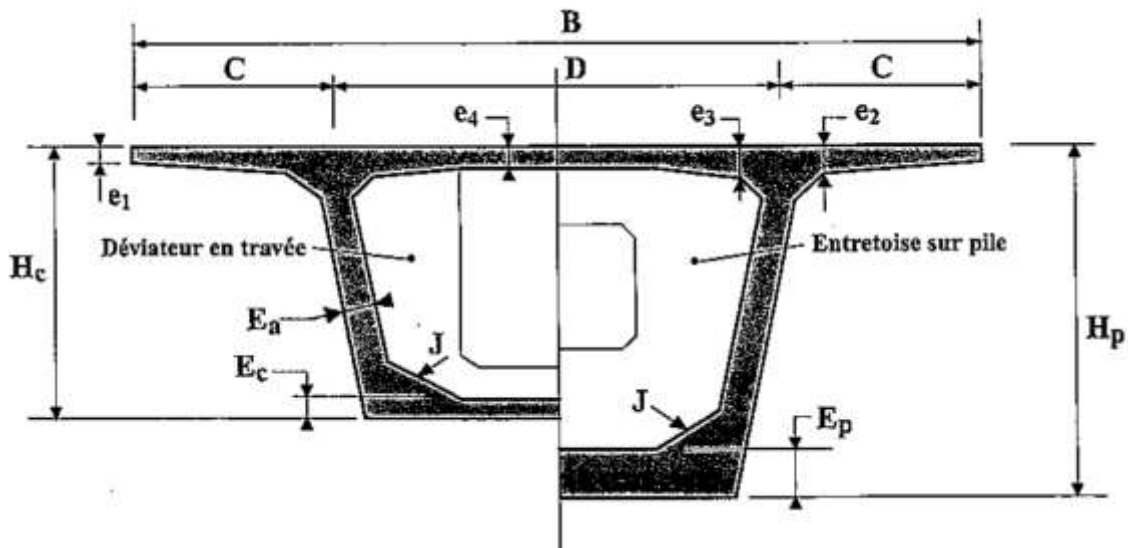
PARAMETRE DE DIMENSIONNEMENT D'UN CAISSON (GUIDE PONT EN BETON PRECONTRAIT)
